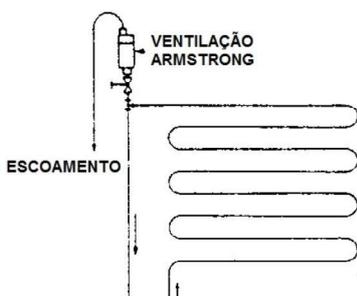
Instalação de ventilação automática em placa de espiral
